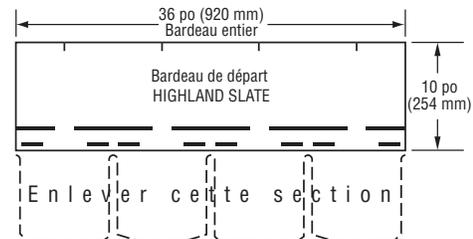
Fabriquer les bardeaux de départ en enlevant 8 po (203 mm) sur la section inférieure.
